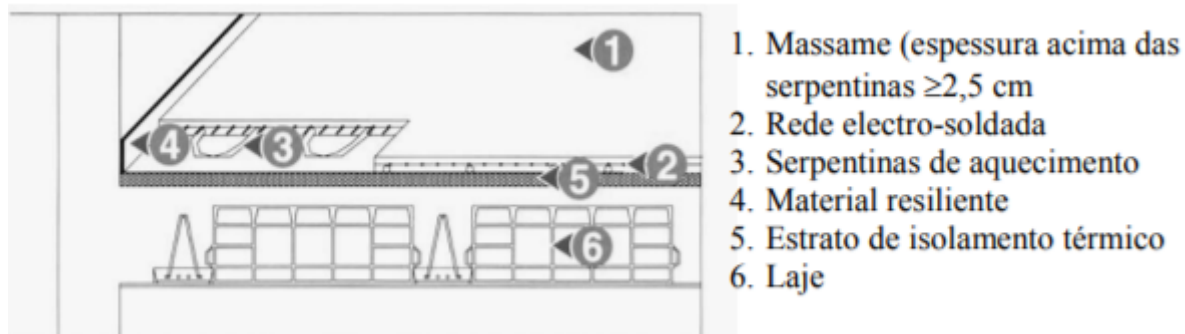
Betonilha radiante (Couto e Lusomapei, 2007)
